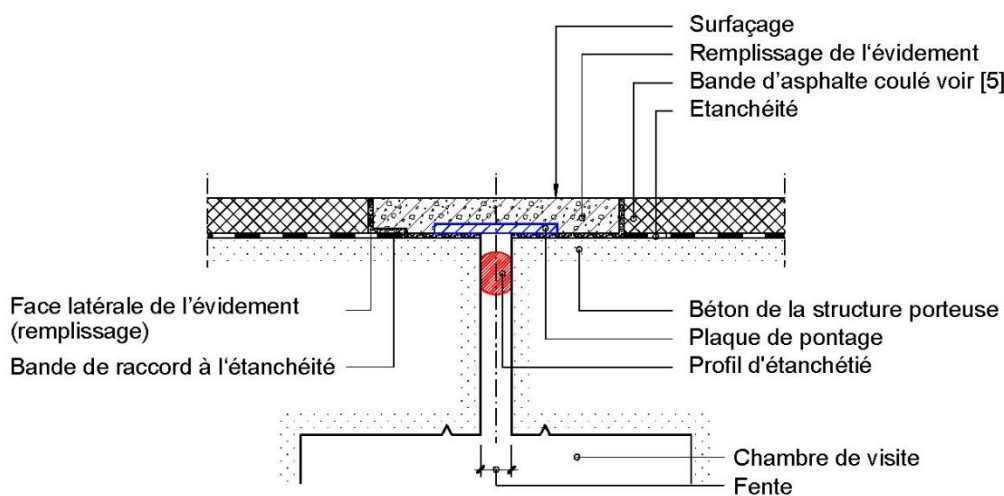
Coupe schématique d'un joint de chaussée en bitume-polymère.
